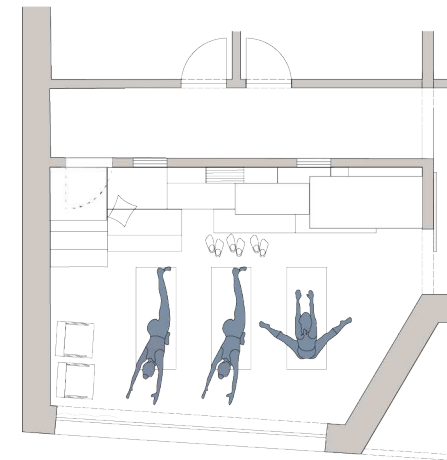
Grundrissvariante 2 - Gemeinsame Sportveranstaltung
